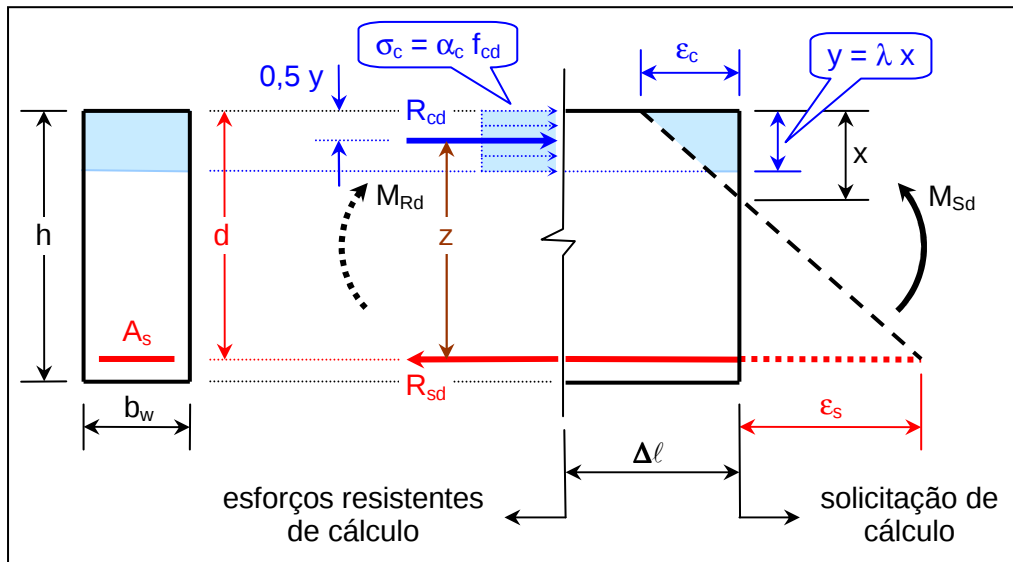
Solicitação e esforços resistentes em vigas de concreto armado
